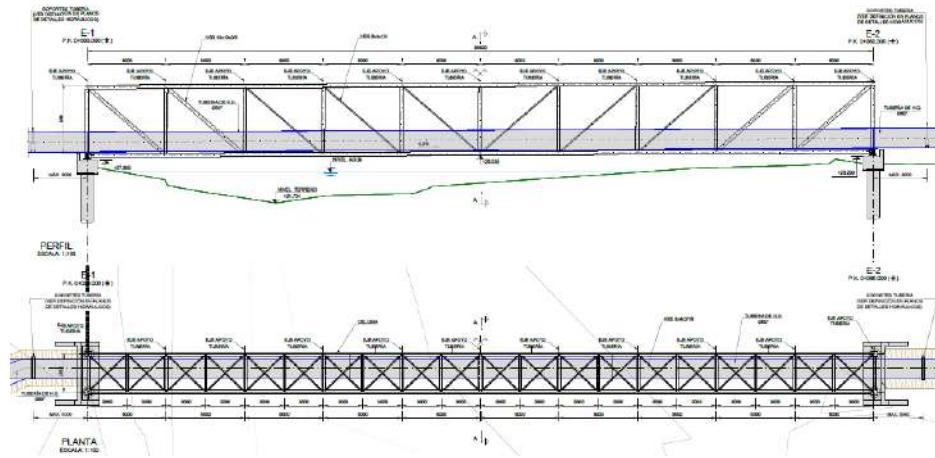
Estructura tipo puente elevado para soporte de tubería de aducción sobre río Mandinga (intersección A),
